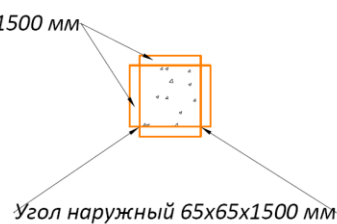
Схема установки щитов опалубки при возведении колонны.
